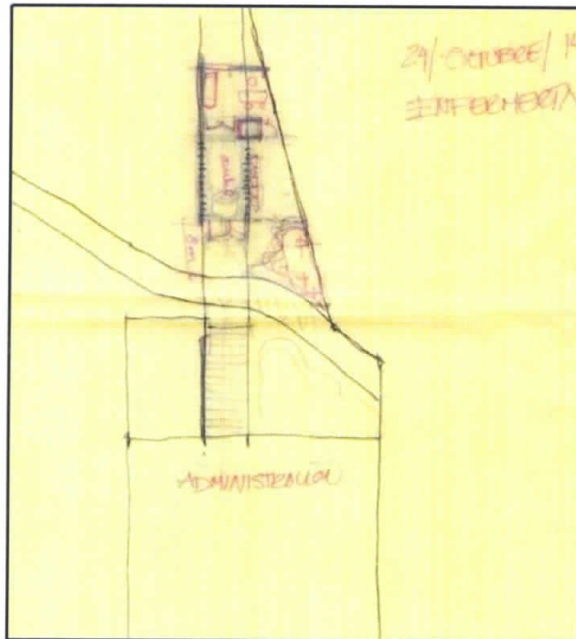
Croquis final de planta-Enfermería. (FUENTE: Coordinación de Vinculación y Proyectos Especiales, Facultad de Arquitectura 2014)
